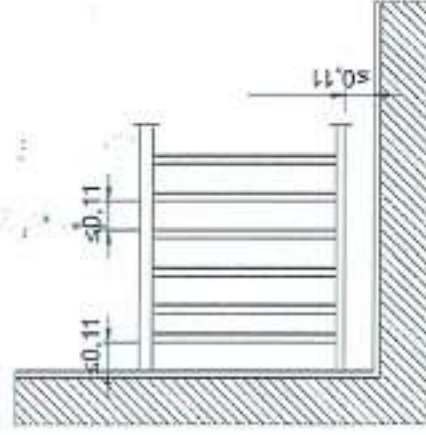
Distância entre perfis verticais (dimensões em metros)
